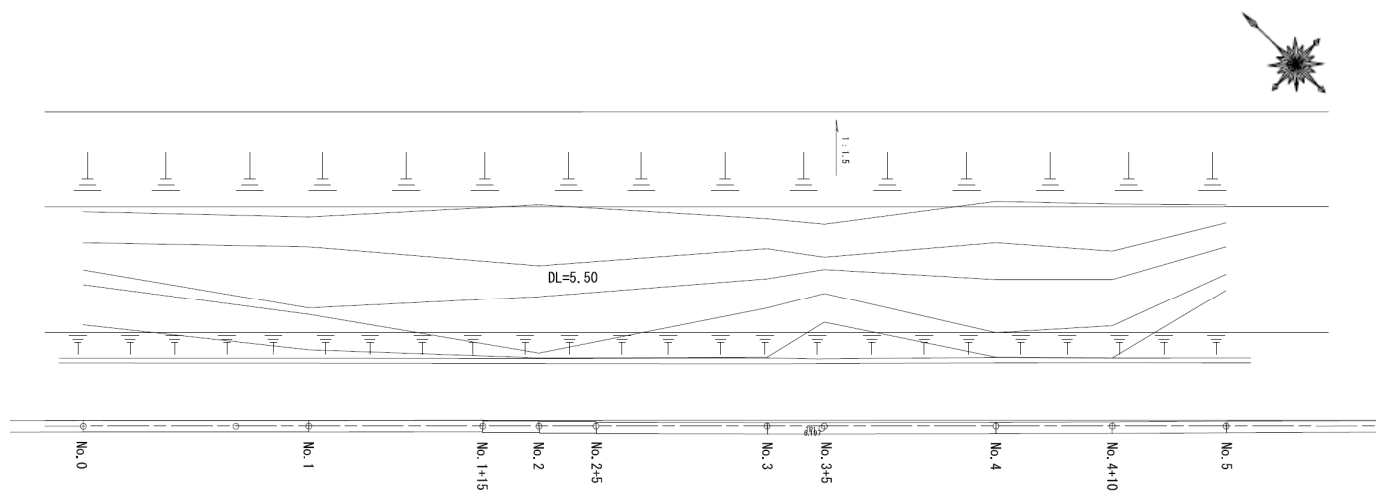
52 No. 7 南海浜正面護岸の平面図（南側）（被災後）
